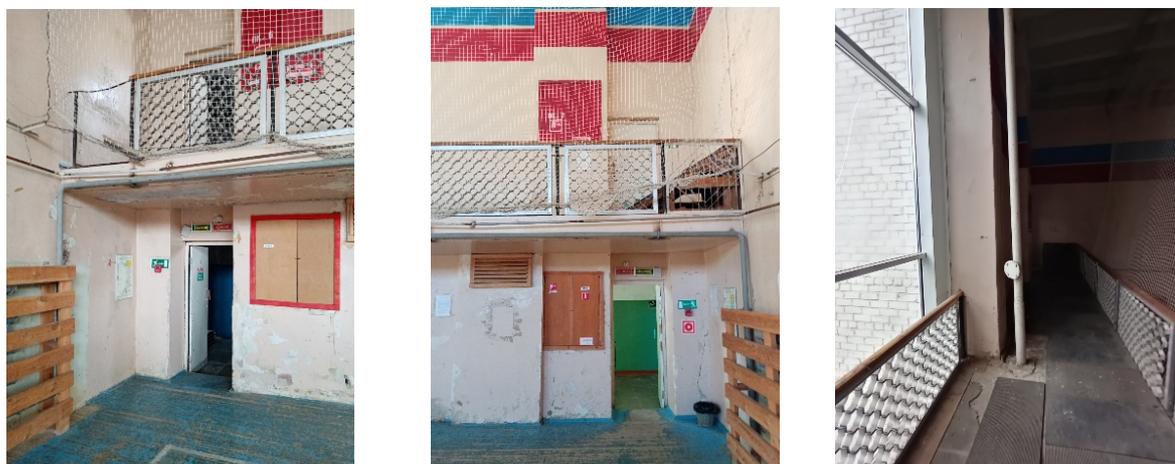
Внутренний балкон на отм. +5.700 для выхода на наружные
